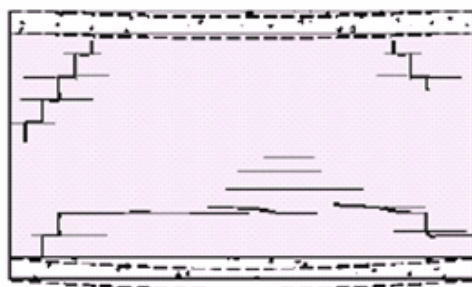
Fissuração do suporte: deformação da viga de apoio maior que a deformação da viga superior [21]
